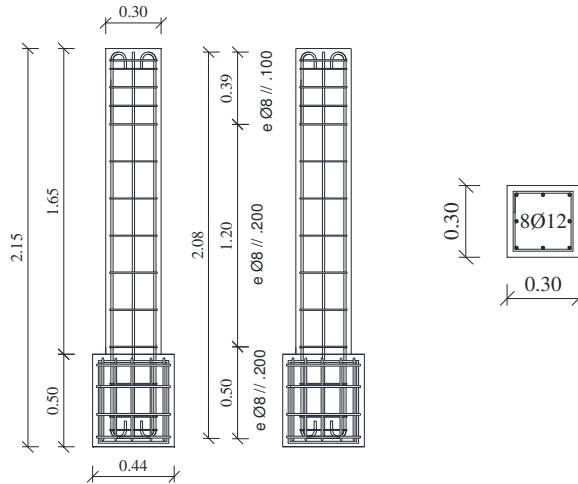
Geometria e pormenores da armadura dos pilares com armadura lisa.
